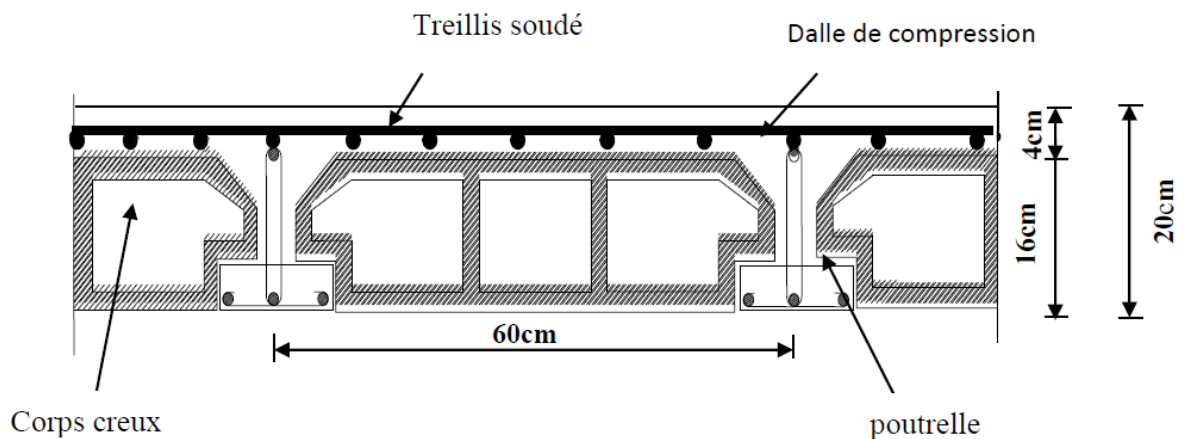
Coupe Verticale d'un Plancher en Corps Creux
